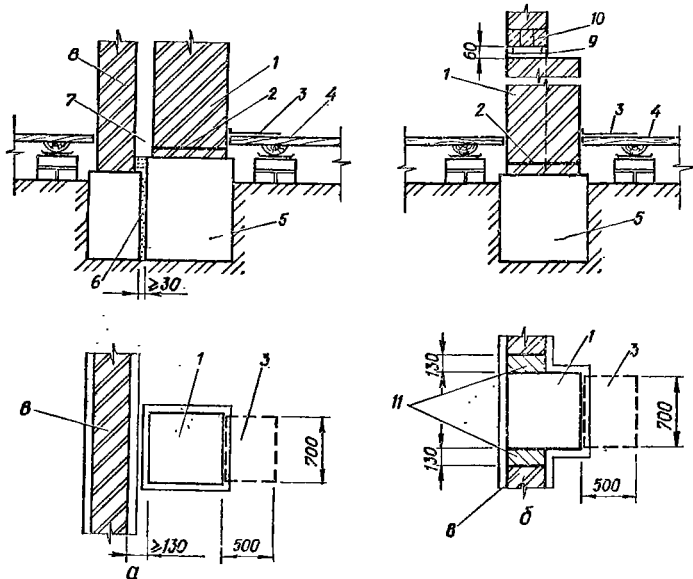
Основания под печи, располагаемые в нижнем этаже здания:
